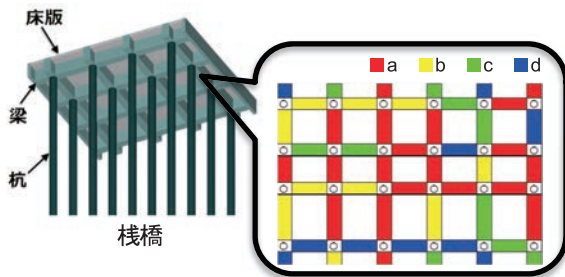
劣化度判定結果を表示した栈橋上部工梁の平面図
